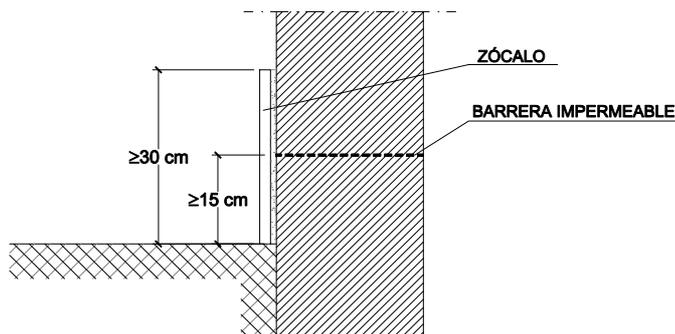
Ejemplo de arranque de la fachada desde la cimentación
